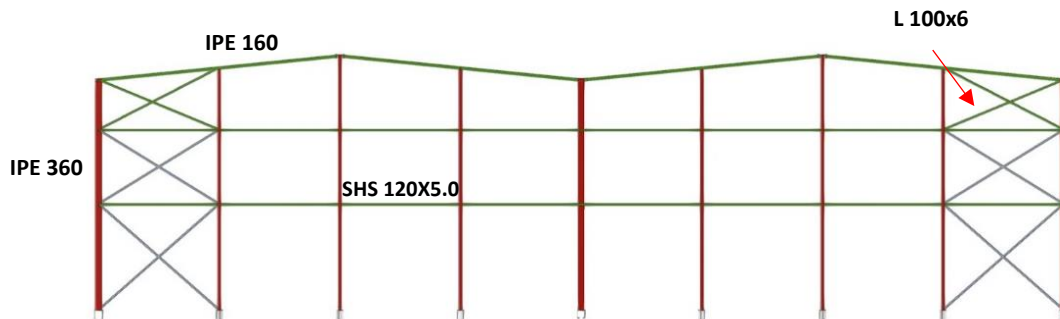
Pórtico de fachada. Fuente: CYPE 3D.
